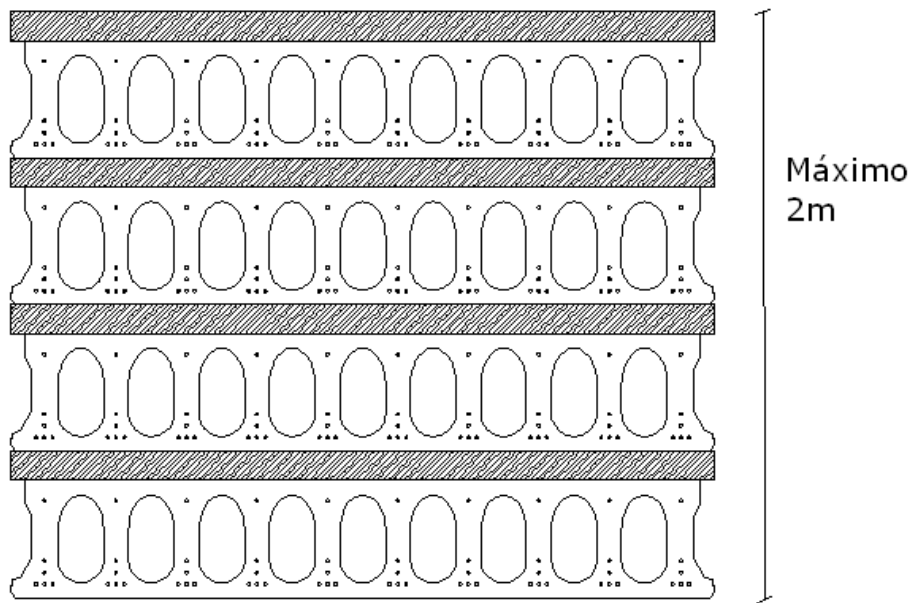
Disposição máxima dos elementos em vista transversal.
